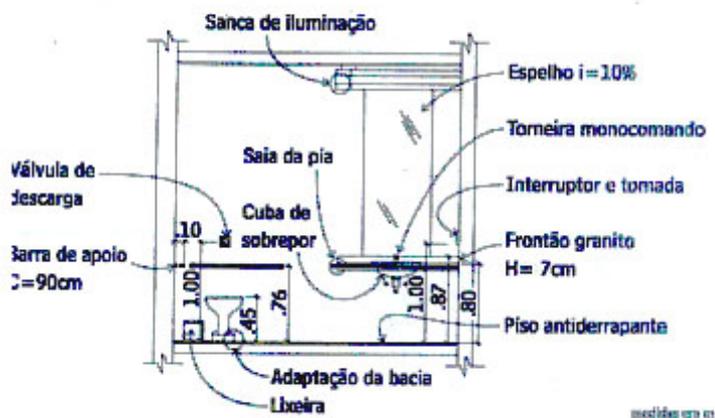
Vista 1 do espaço interno banheiro acessível (ORNSTEIN e CAMBIAGHI, 2003)
